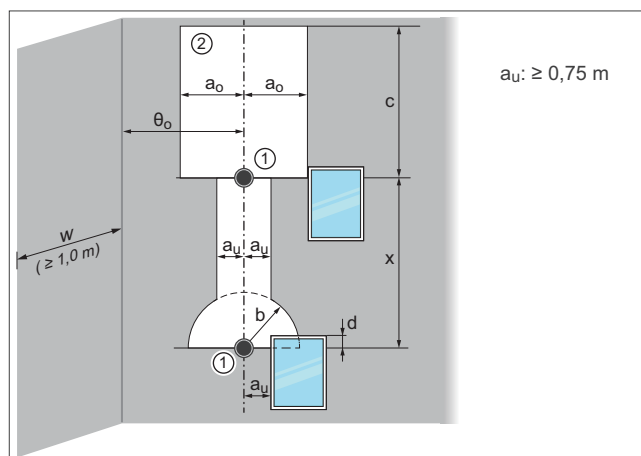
Mündungen an Gebäudefassaden (senkrechte Anordnung)
